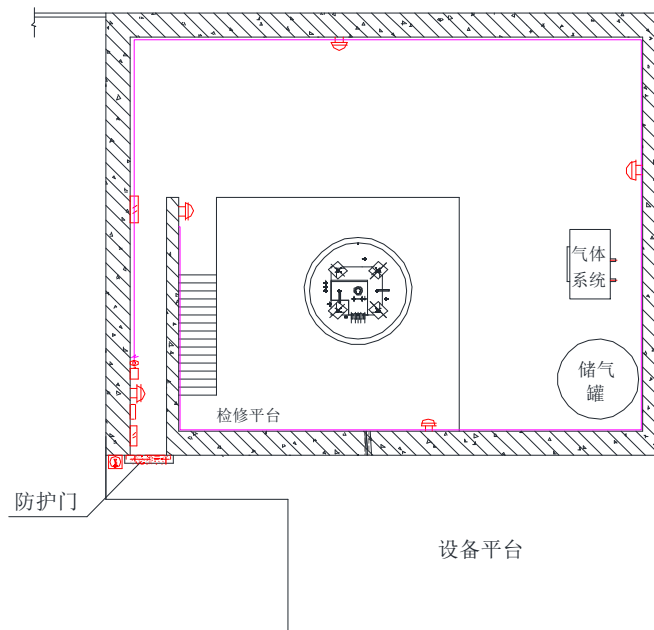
2.5MeV电子加速器机房排风系统平面图及剖面图  北
